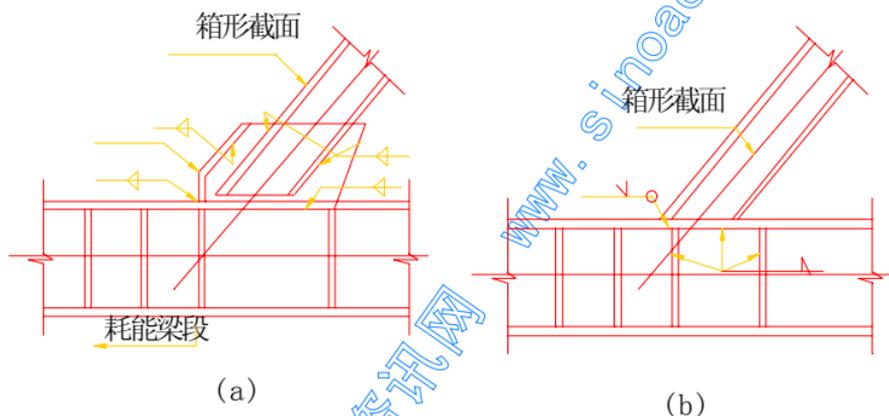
支撑与耗能梁段轴线交点的位置
